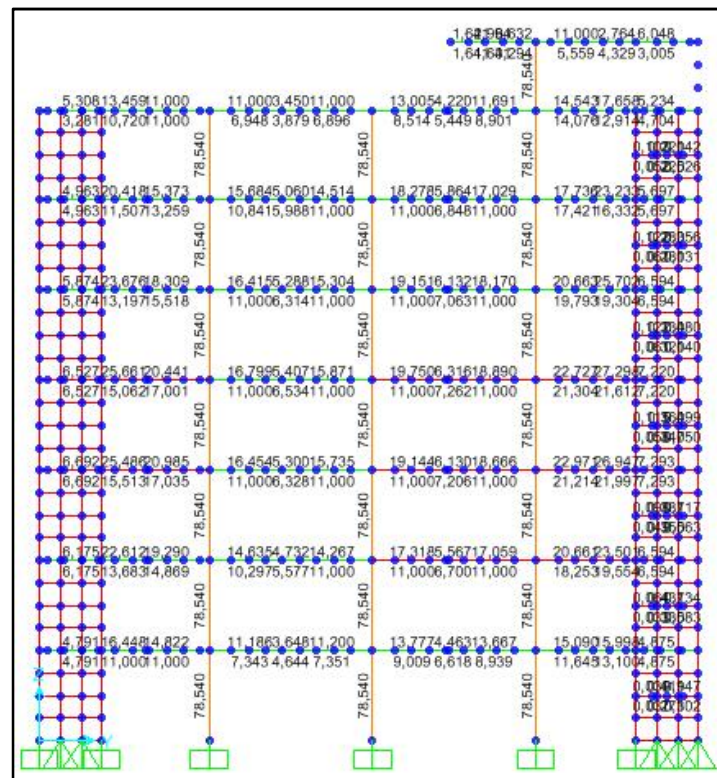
Acero en vigas pórtico o (Crítico en Y), Hall Central
